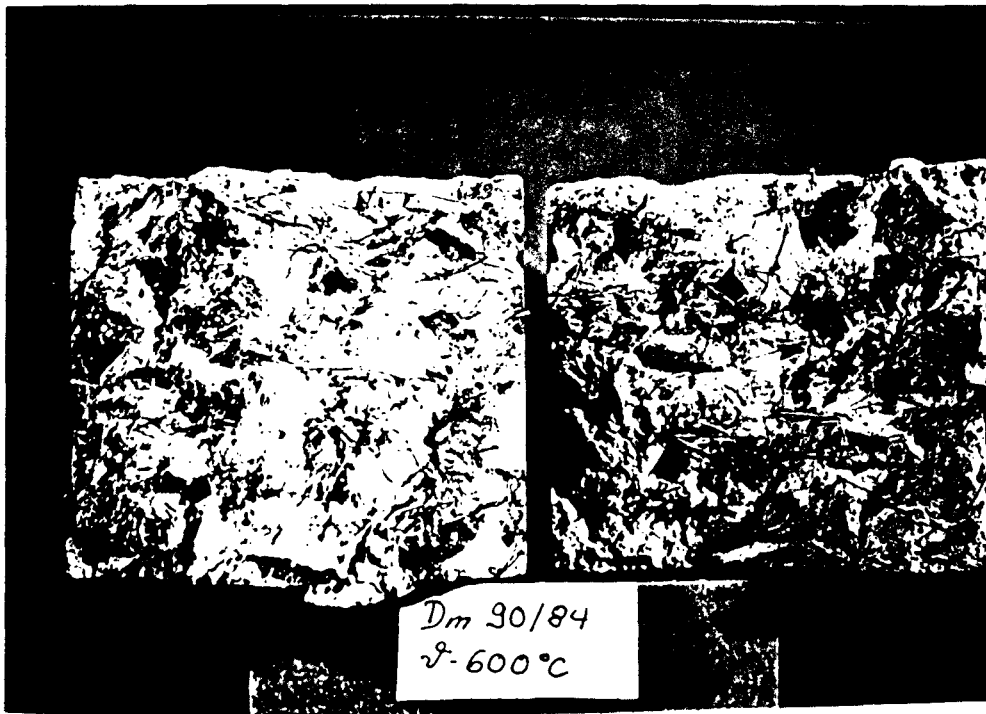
Bruchfläche eines bei 600 °C geprüften, stahlfaserbewehrten Diabasbetonprobekörpers
